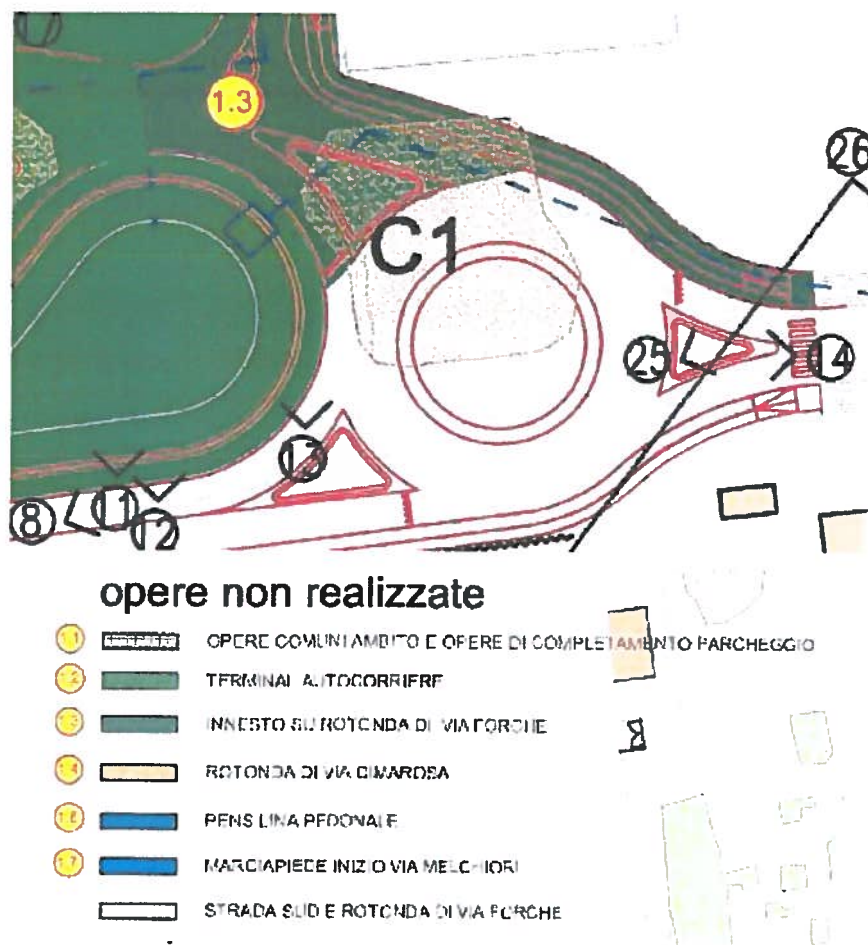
Estratto della Planimetria di Progetto del P.I.R.U.E.A. M2
